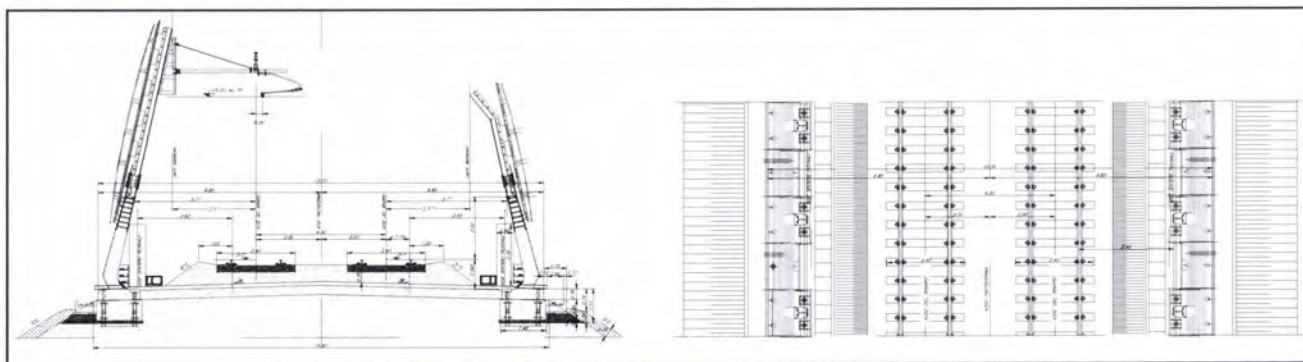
Sezione Tipo doppio binario in Rilevato con Barriere Antirumore
